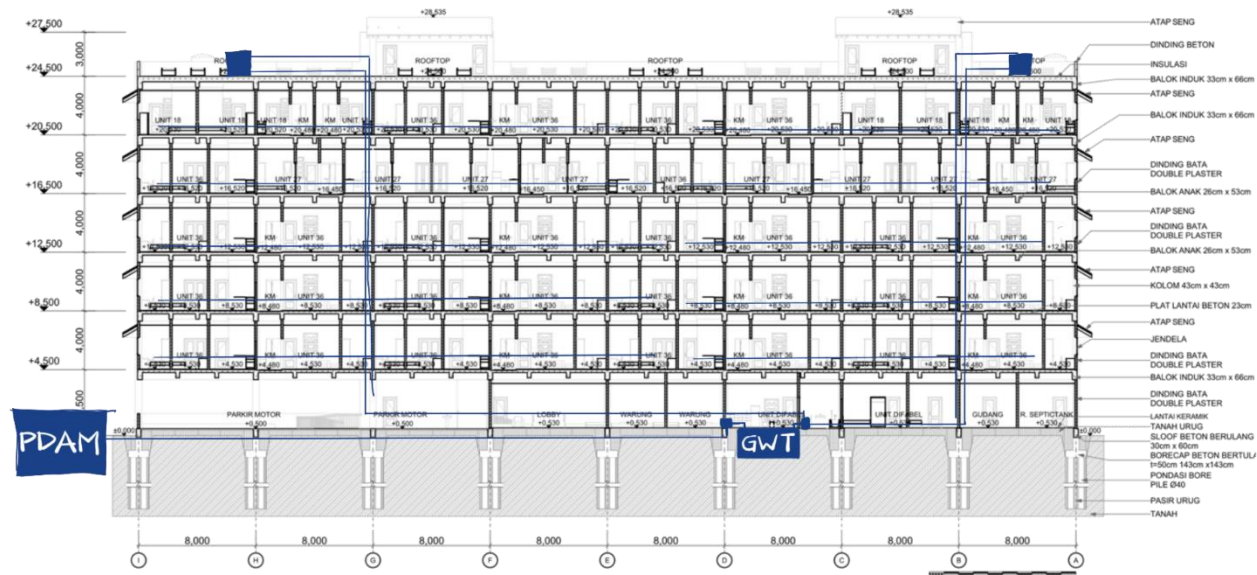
Skema Rencana Struktur pada Bangunan Rusun
